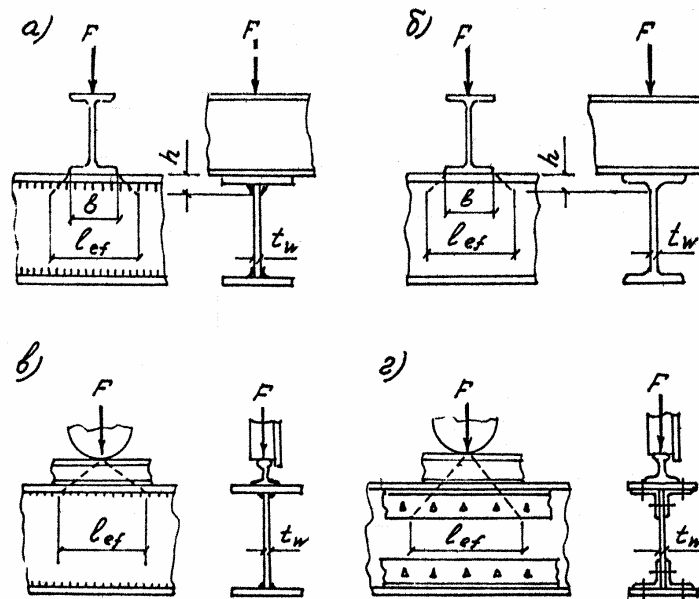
Схема розподілу зосередженого навантаження на стінку балки:
